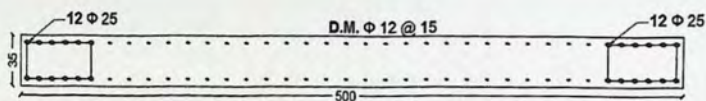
Sección transversal Muros 1 y 2, Edificio B
